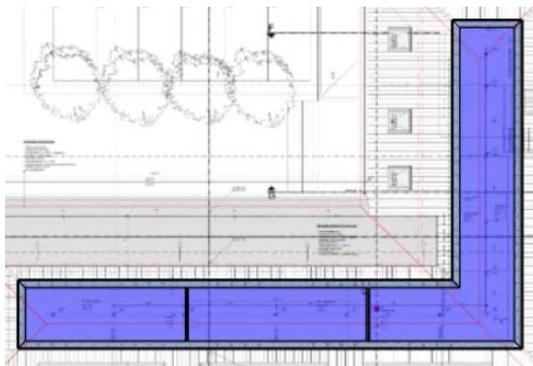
Grundriss Spitzboden, zoniert
